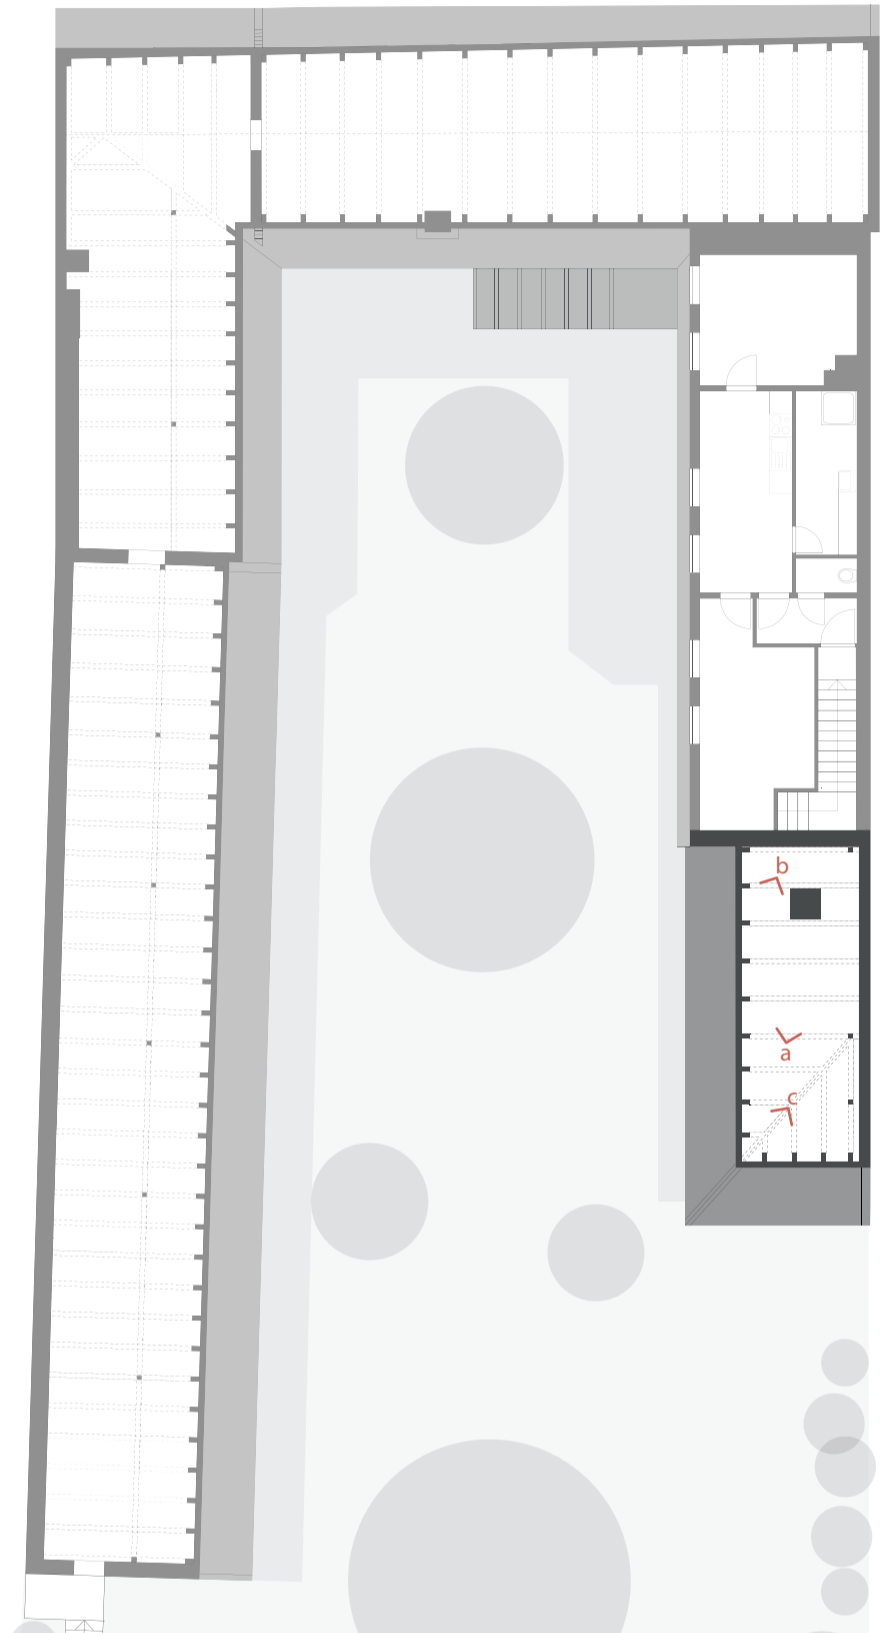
Grundriss Dachgeschoß | M 1:200 | Raum 30
